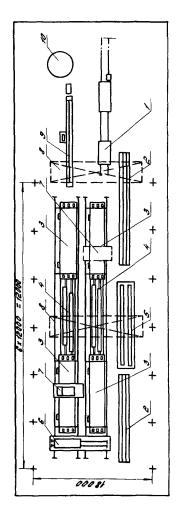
Схема цеха по изготовлению коробчатых настилов
